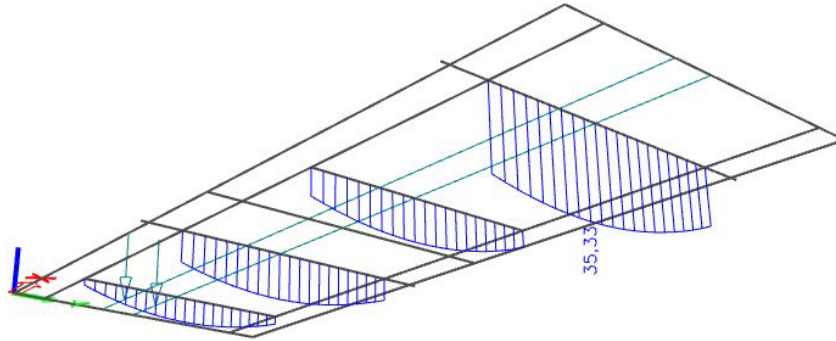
Renderovaný model pro návrh betonářské výztuže
